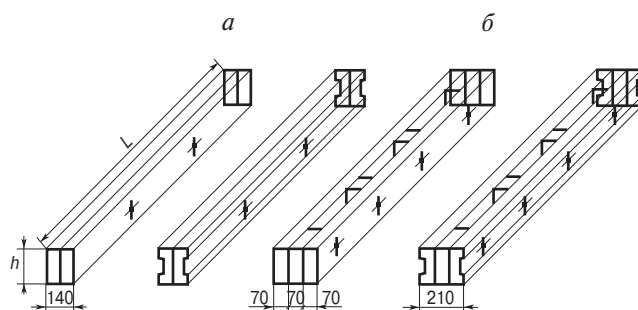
Конструкция из силикатобетонных линейных элементов: а – спаренные элементы; б – элементы с прокладками из силикатного бетона и других материалов
